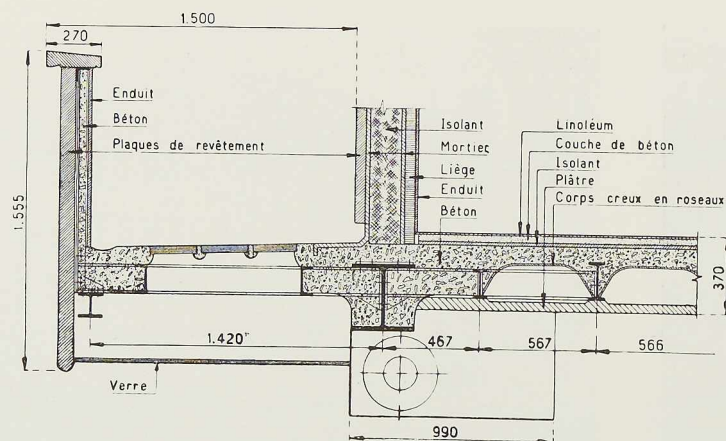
Coupe dans un hourdis avec coffrages perdus en roseaux. Détail d'un balcon avec plancher translucide.
